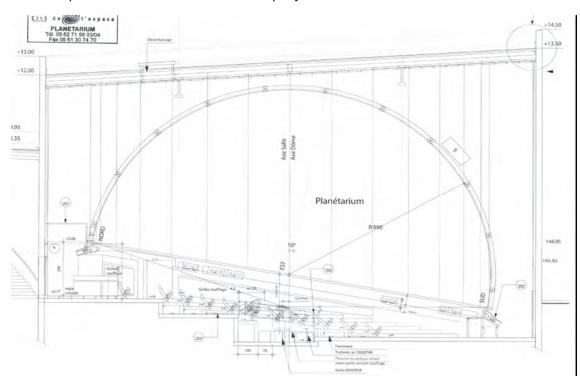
Illustration d'une coupe d'un planétarium (Cité de l'espace à Toulouse – capacité de 270 places)
